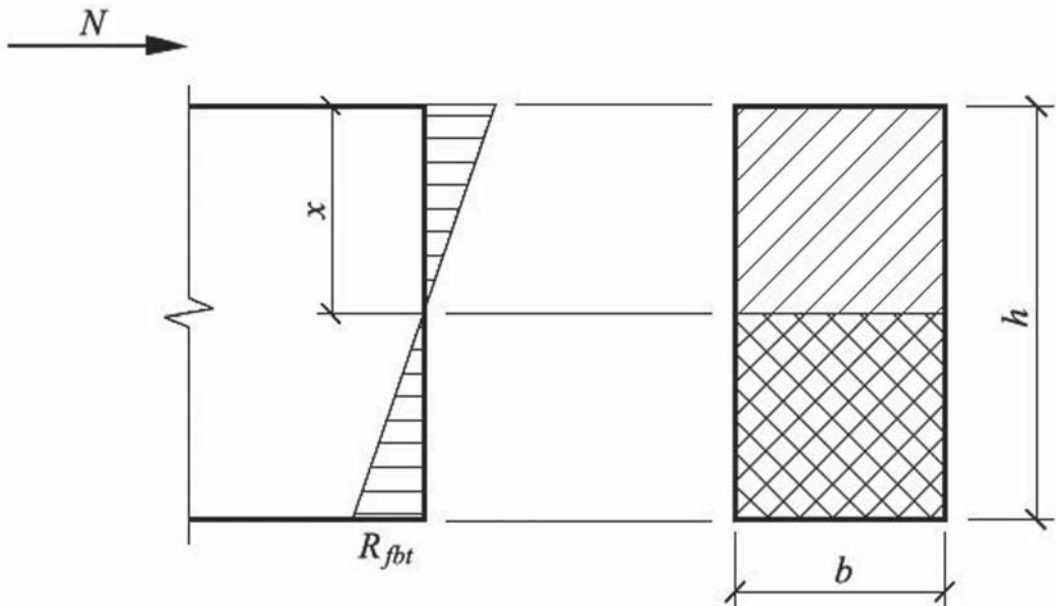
Схема усилий и эпюра напряжений в сечении нормальном к продольной оси внецентренно сжатого фибробетонного элемента, рассчитываемого по прочности с учетом сопротивления фибробетона растянутой зоны
